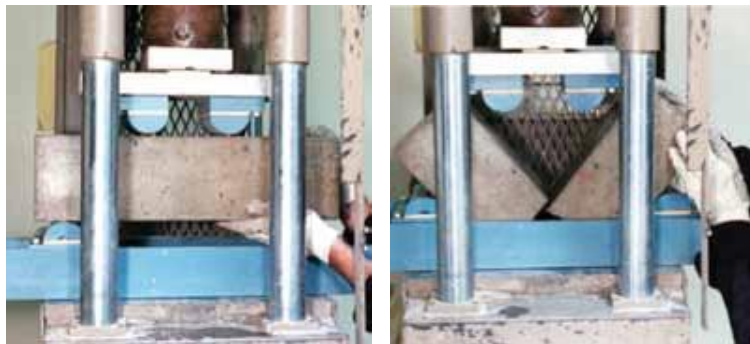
Aplicación de carga a espécimen. (INECYC I. E., 2009)
